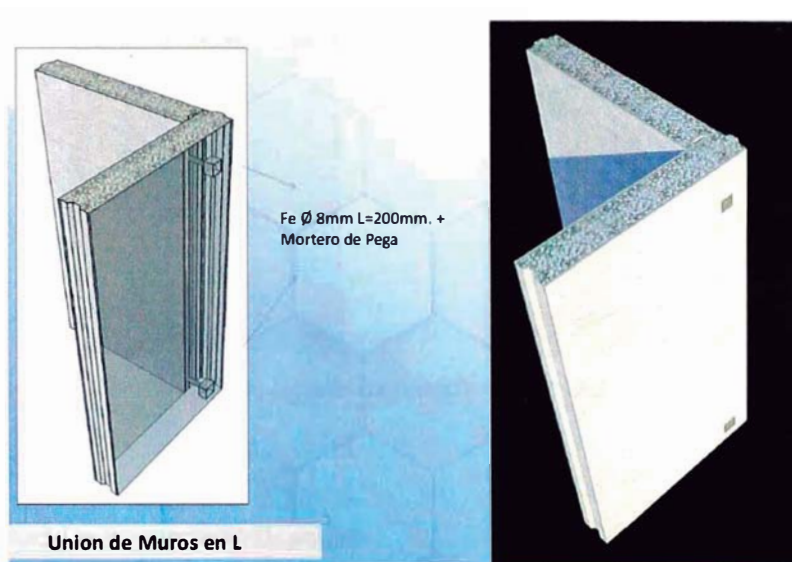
Detalle de colocación y anclajes en un encuentro en L
